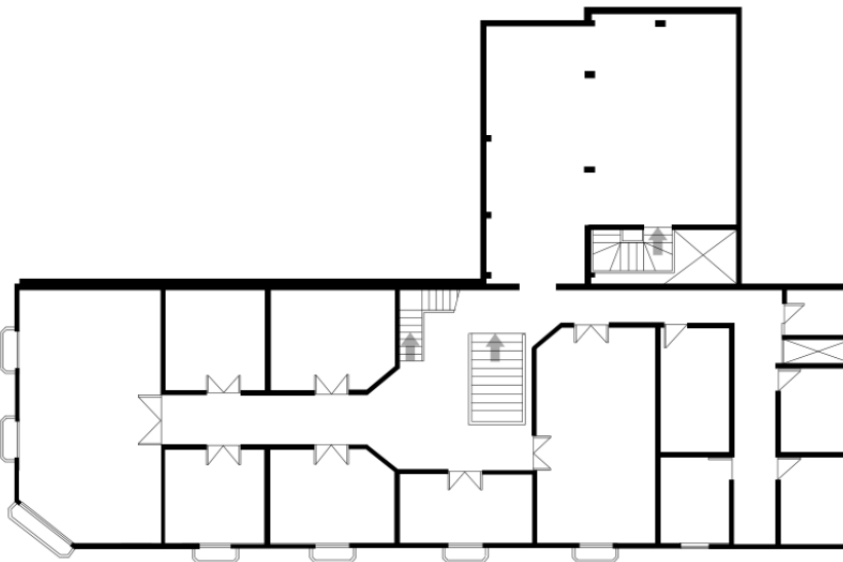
Planta arquitectónica del Primer piso: 400 m2
